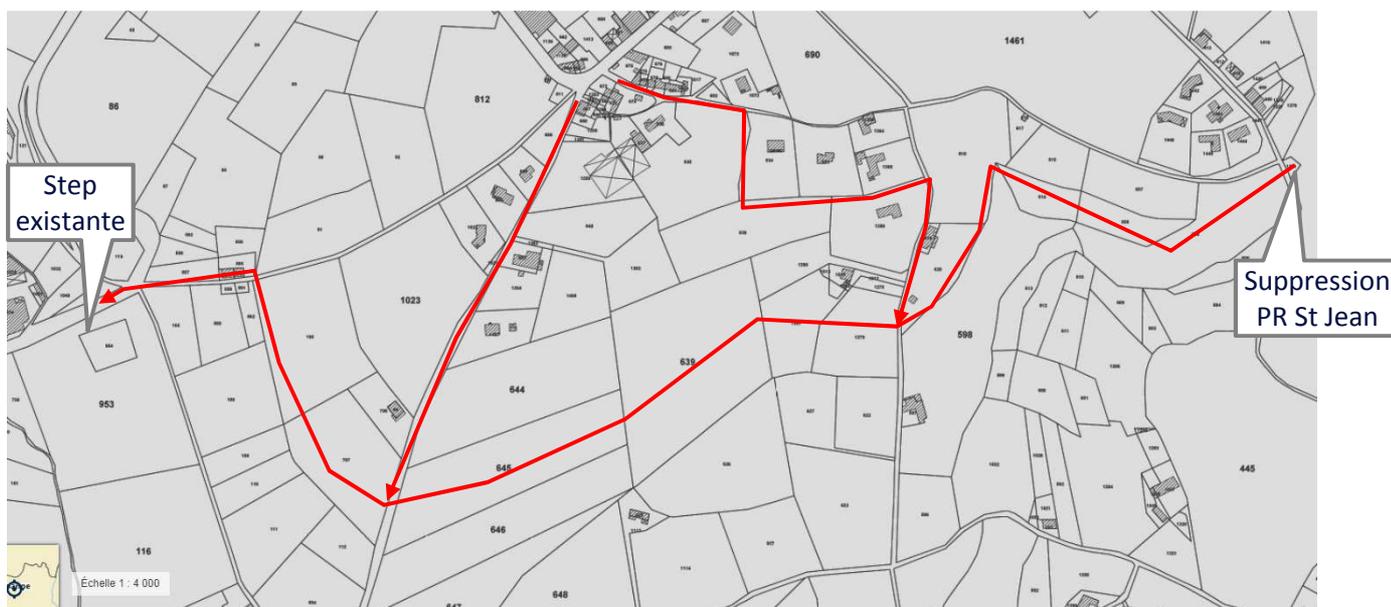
Plan de situation des travaux solution raccordement sur la STEP
